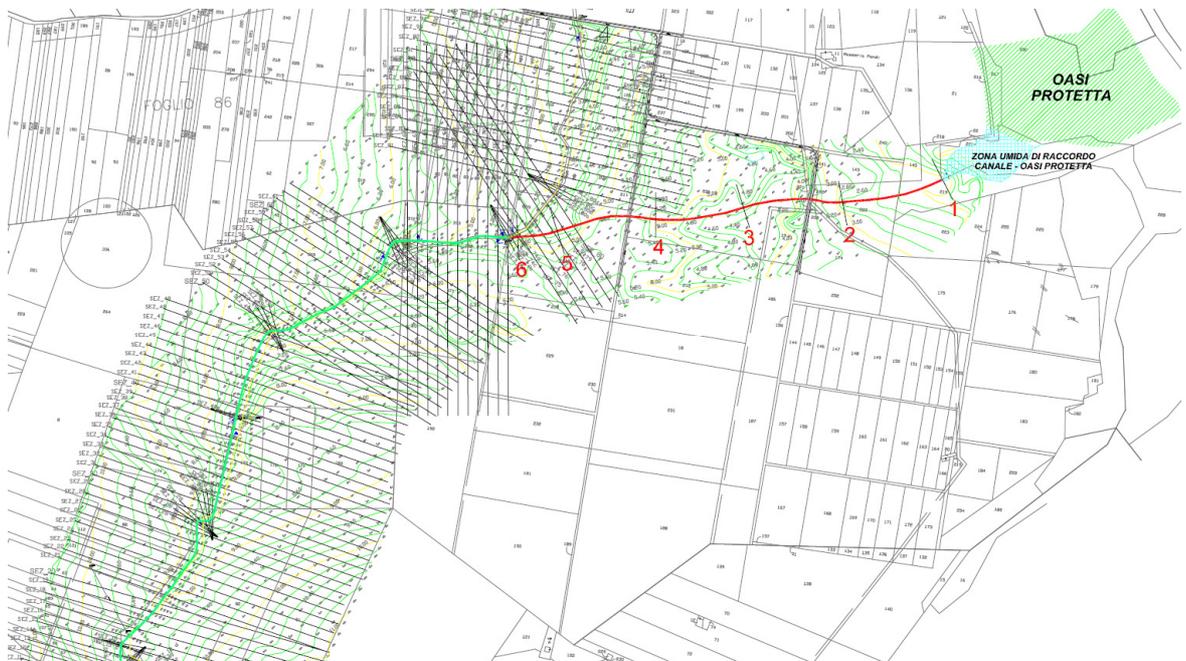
Tracciato del canale in progetto (in colore rosso) con sezioni
